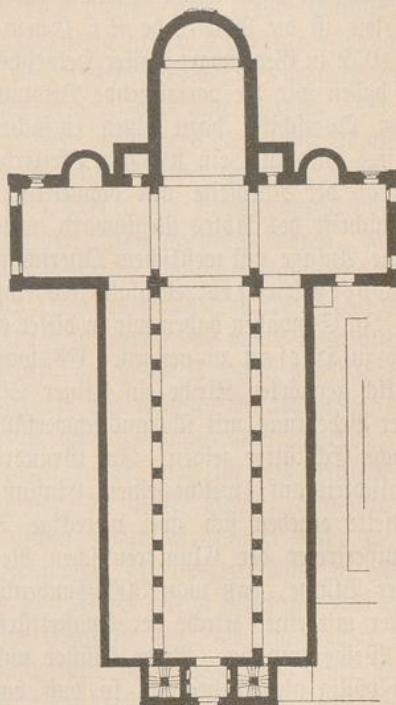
Grundriss des Doms zu Würzburg.
